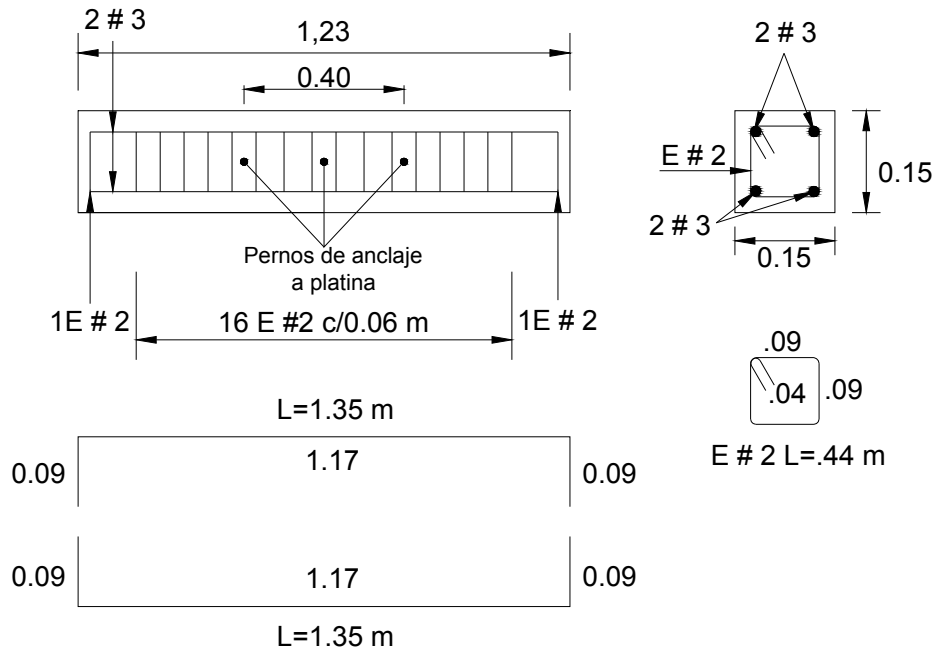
Proceso constructivo de las vigas de borde superior.
